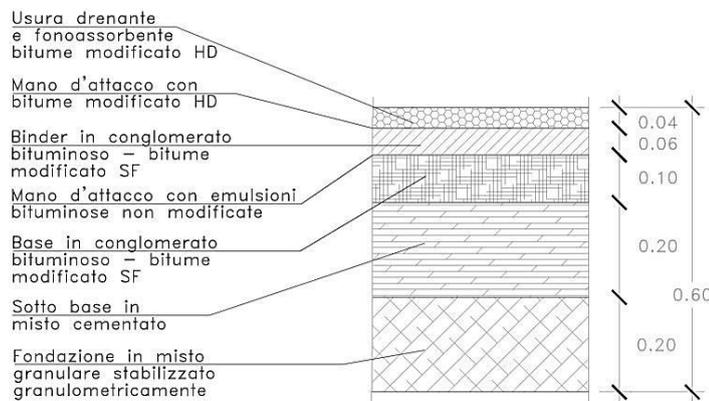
Variante di Longarone – Pavimentazione stradale
